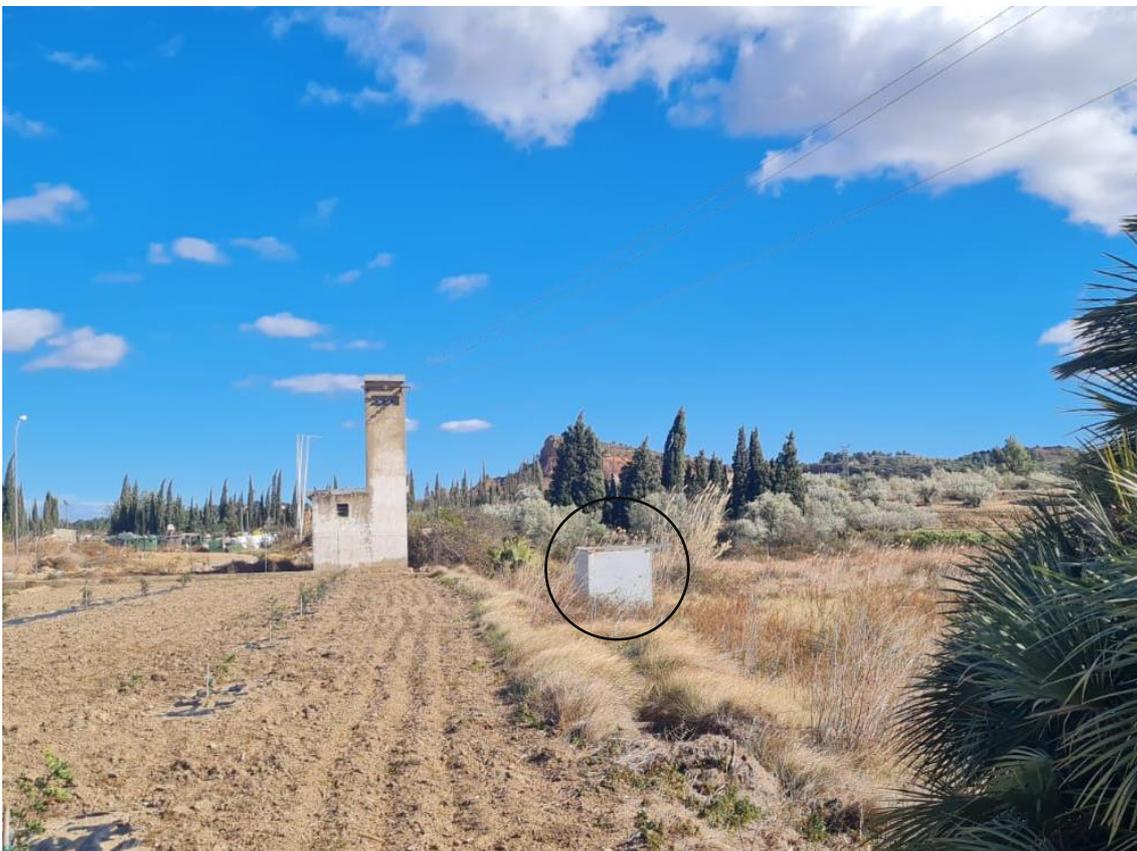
Construcción nº8. Fuente: Elaboración propia.
